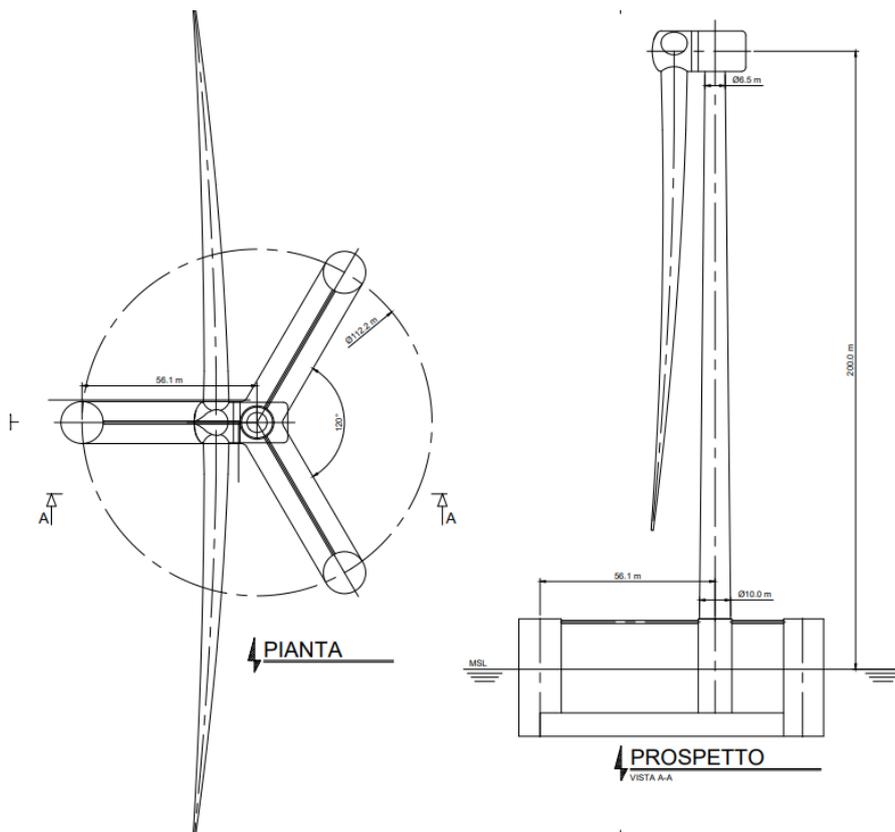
Prospetto dell'insieme fondazione-turbina (fonte: Tavola OW.ITA-SAR-GEN-OWC-ENV-DWG-53A).
